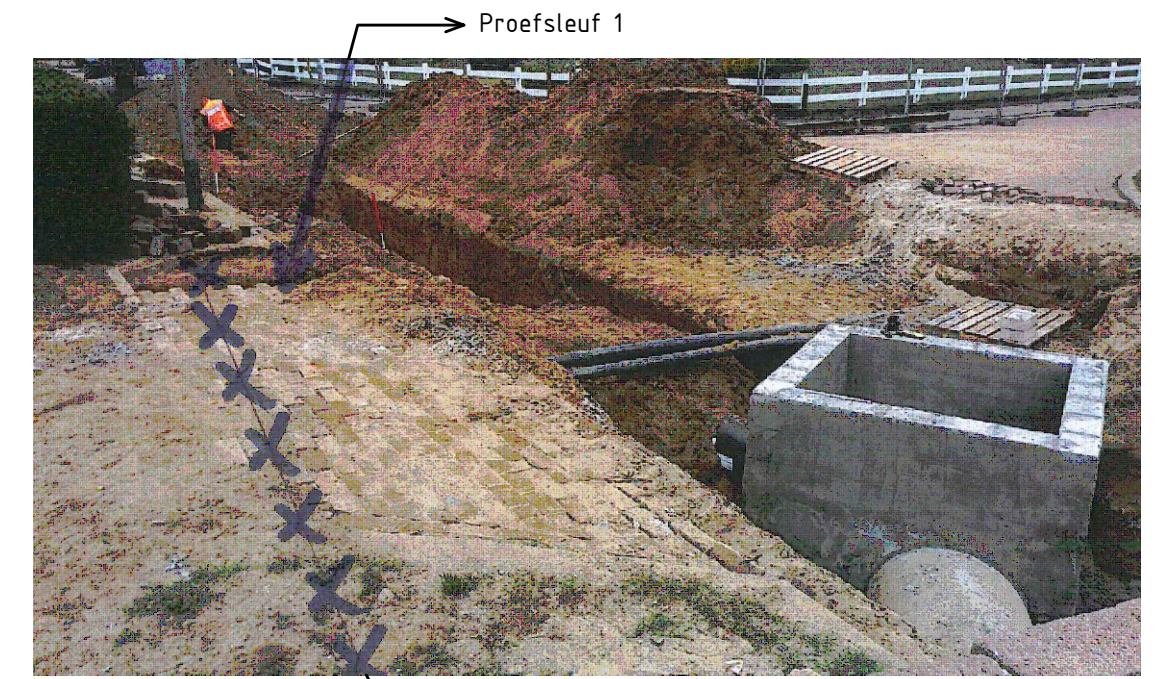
Verwijderen 6m beton ø500 tussen Put02 en proefsleuf 1
